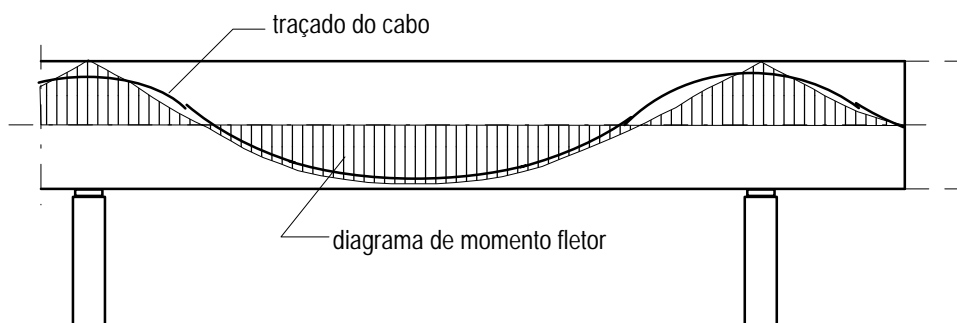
Perfil dos cabos em vigas hiperestáticas.
